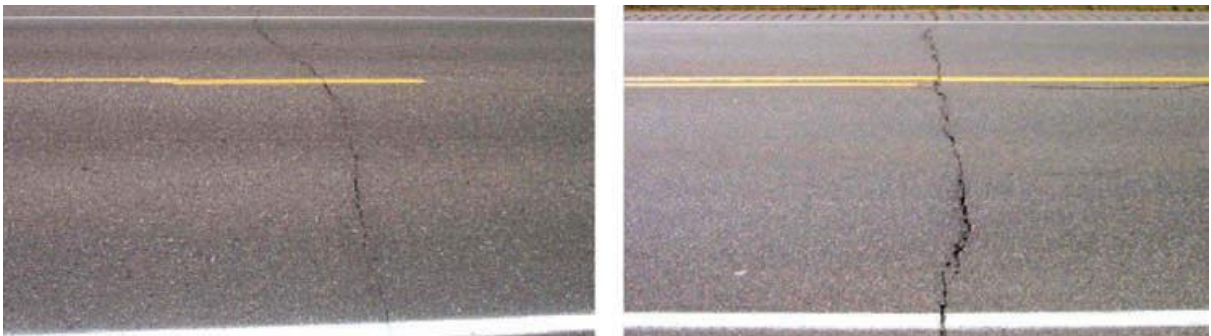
Fissuras transversais. (ANE 2021)
